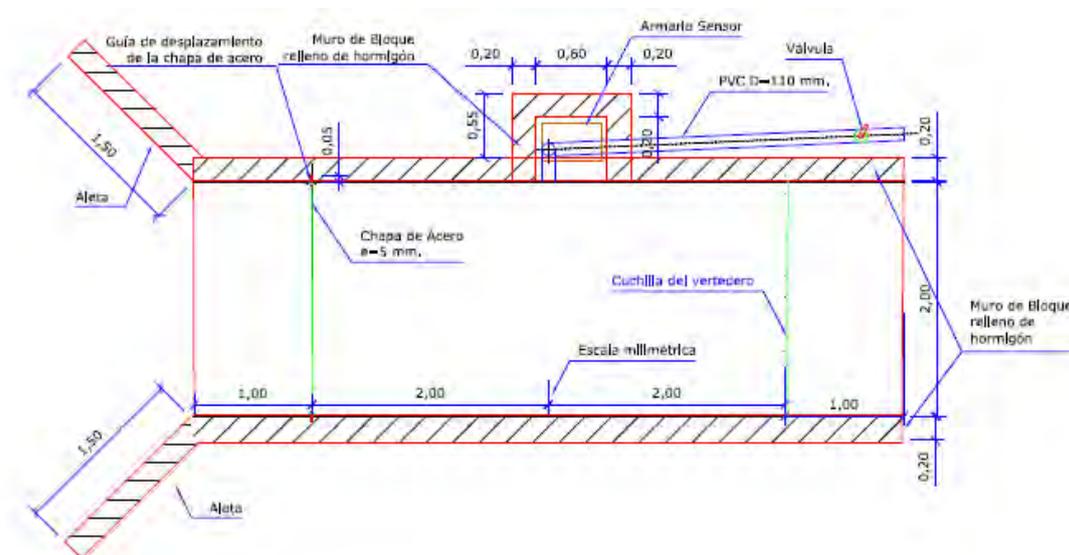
Planta de la sección de aforo realizada en el arroyo Nogueras para la medida de caudales
